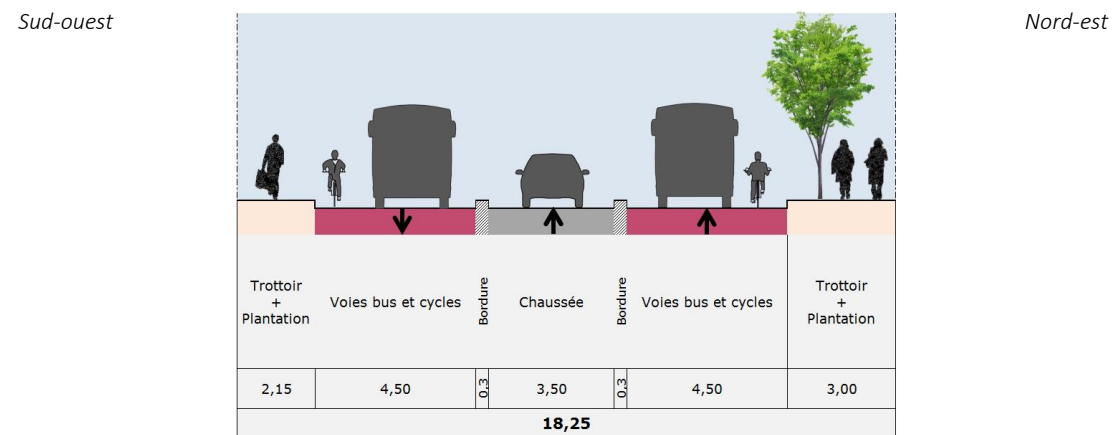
Coupe type sur le boulevard Maurice Berteaux - Variante 2
